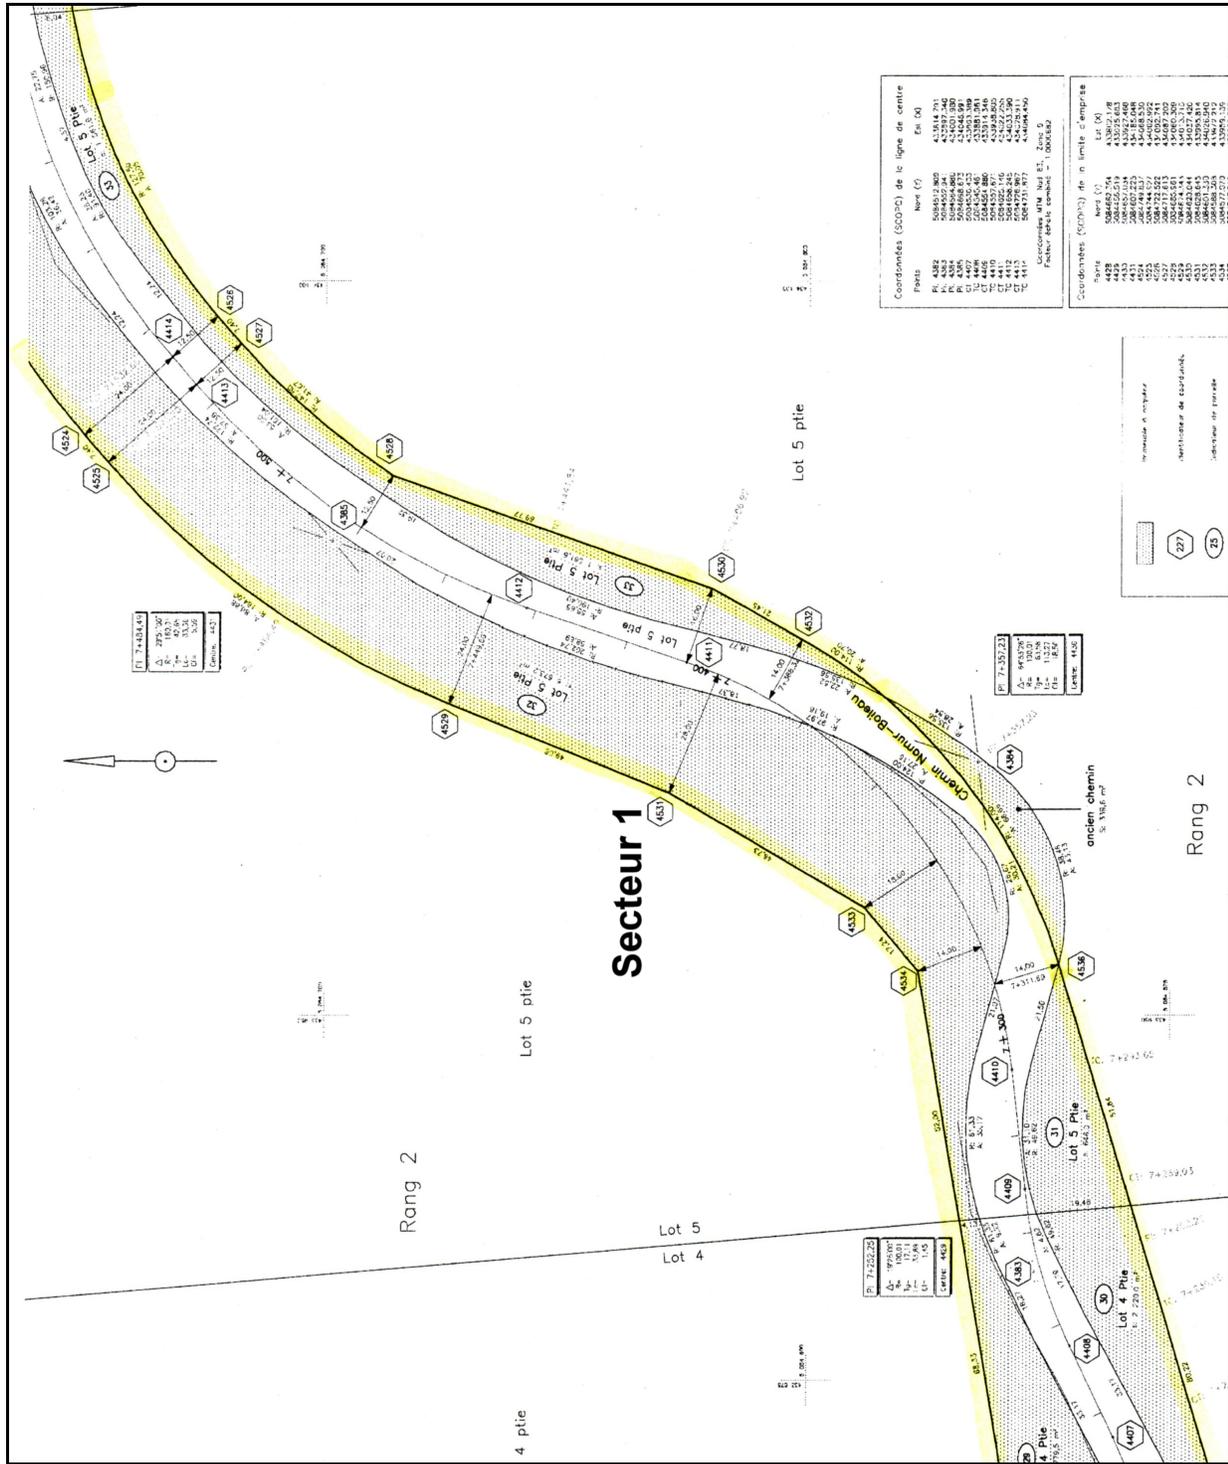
Localisation des secteurs d'inventaire sur le plan de construction du projet 20-6671-8035 (3/5)
